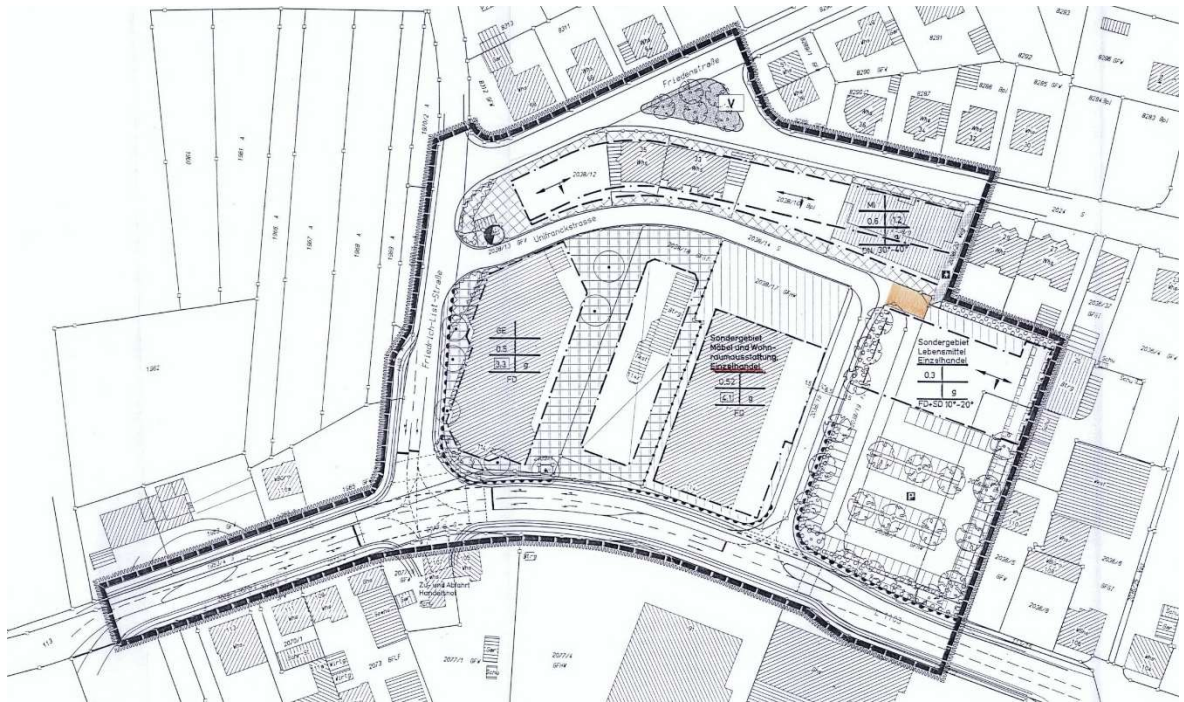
Bebauungsplan „Unifranck, 5. Änderung“, 2002
